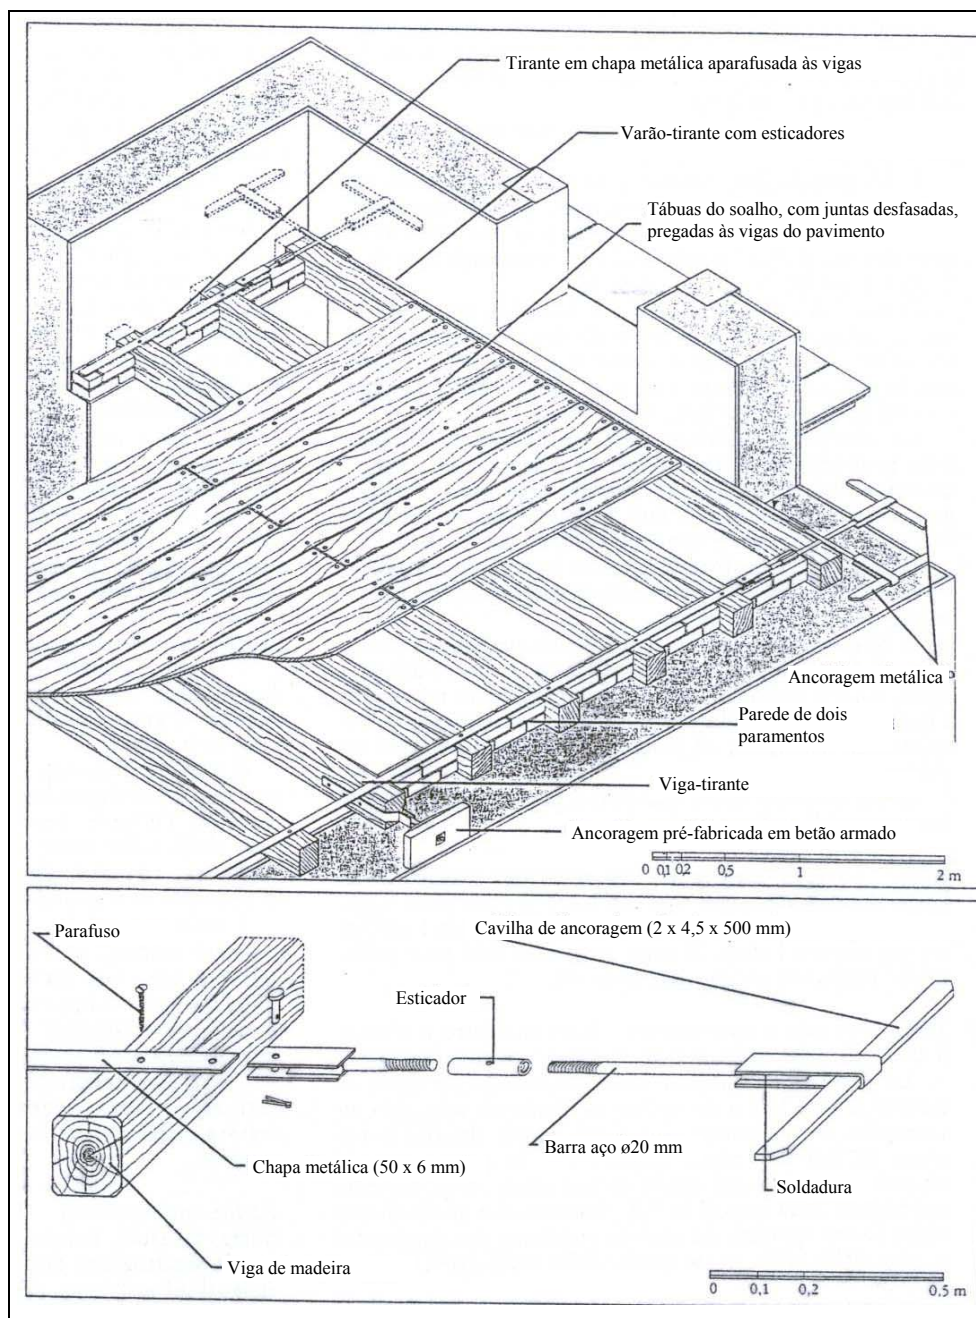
Exemplo da aplicação de pregagens para melhoria das ligação entre paredes e pavimentos de madeira [Giuffrè, 1993].
